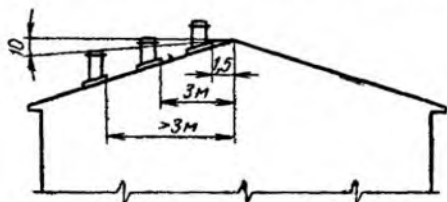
Расположение верха дымовой трубы относительно конька крыши
